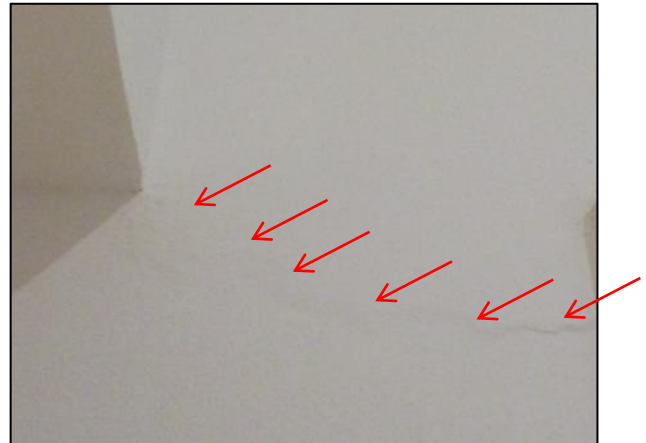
y 10.- Fisuración en piso 2º2º.
